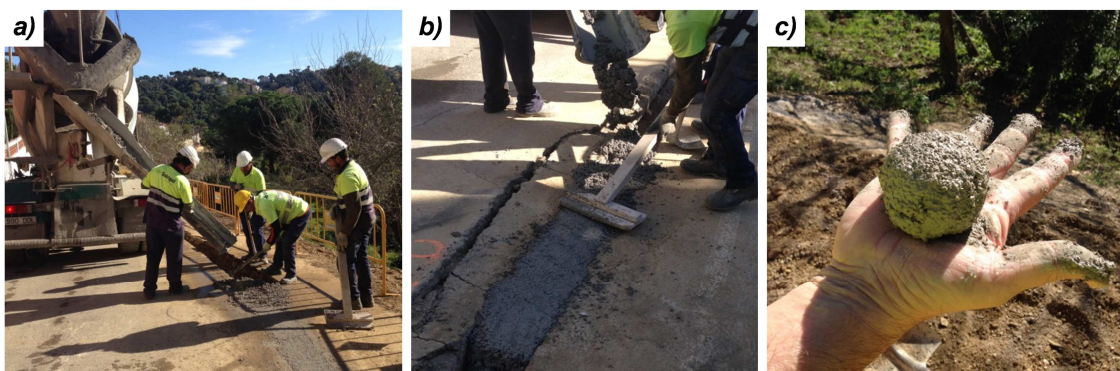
118 – a) vertido del hormigón; b) extendido del hormigón en la zanja; c) detalle del hormigón
